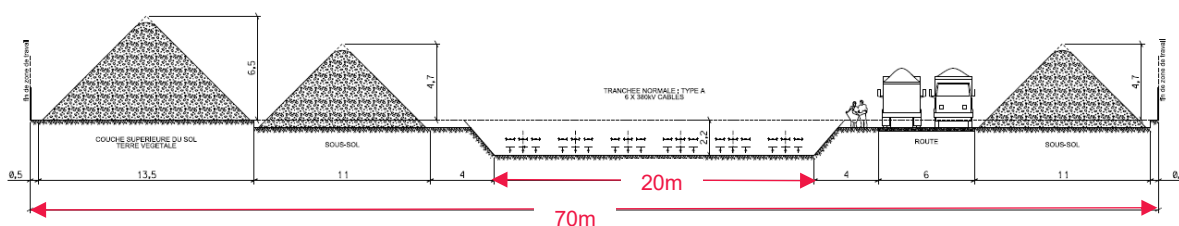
section transversale d'une zone de chantier avec câbles 380 kV (source : Note technologique d'Elia, 2019).
